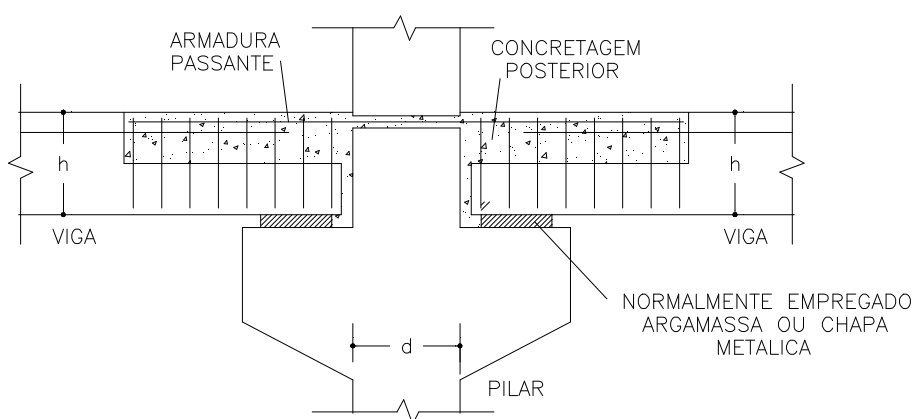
Ligação Rígida Pilar-Viga Simétrica
